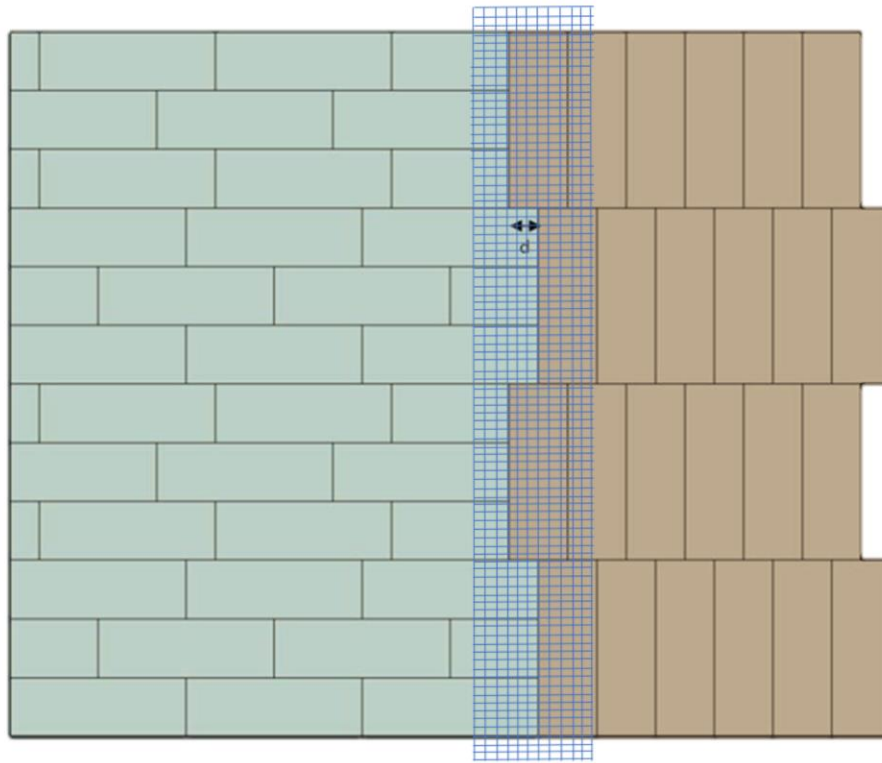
Plans de chevillage – panneaux STEICOprotect L dry de dimensions 1200 x 400 mm – chevillage « en plein et en joint »
